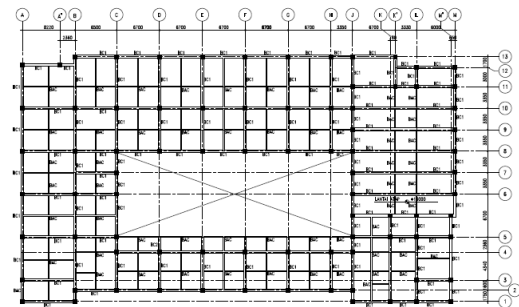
Denah kolom, balok dan pelat lantai Ground
